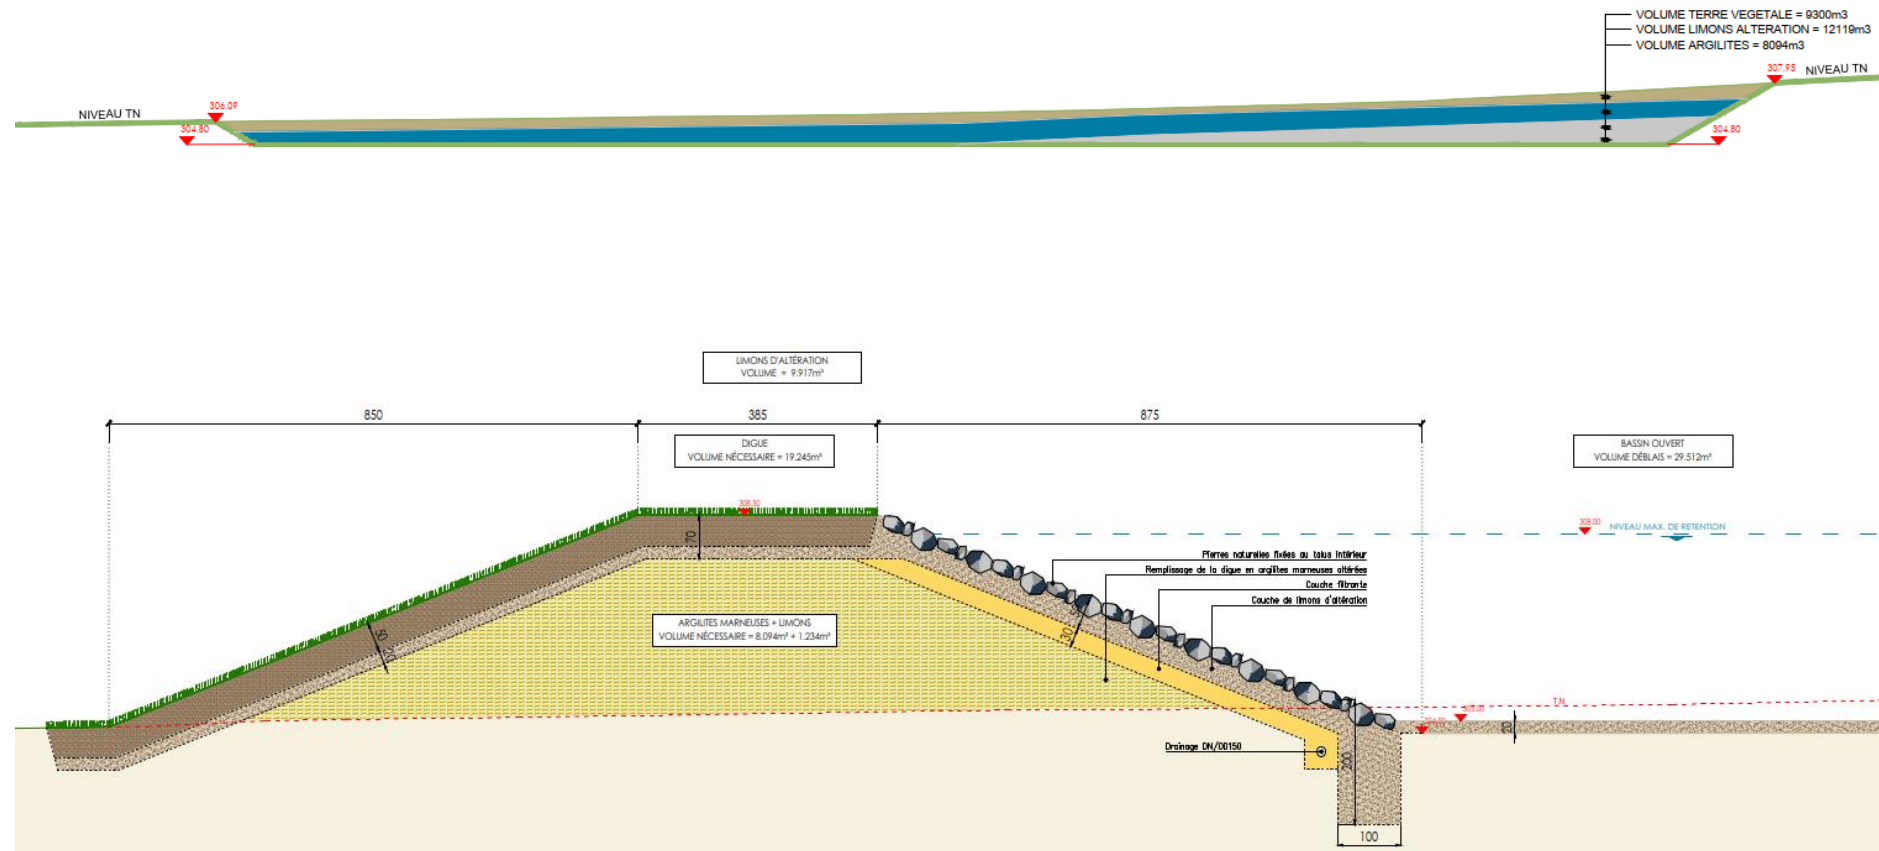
Auszug aus dem Plan „Concept du Bassin – Vue en plan et profil en long“ (Luxplan S.A. 05/2022).
